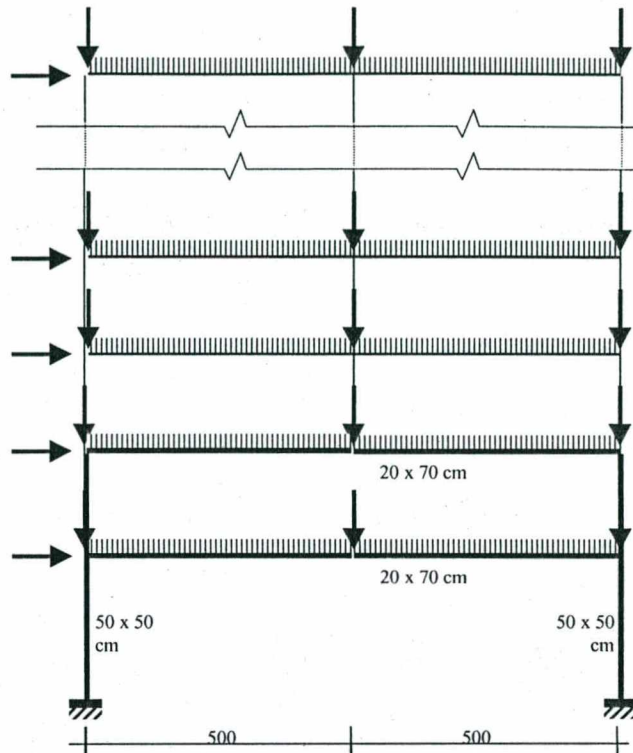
Exemplo 9 – Pórtico de 15 pavimentos com viga de transição
